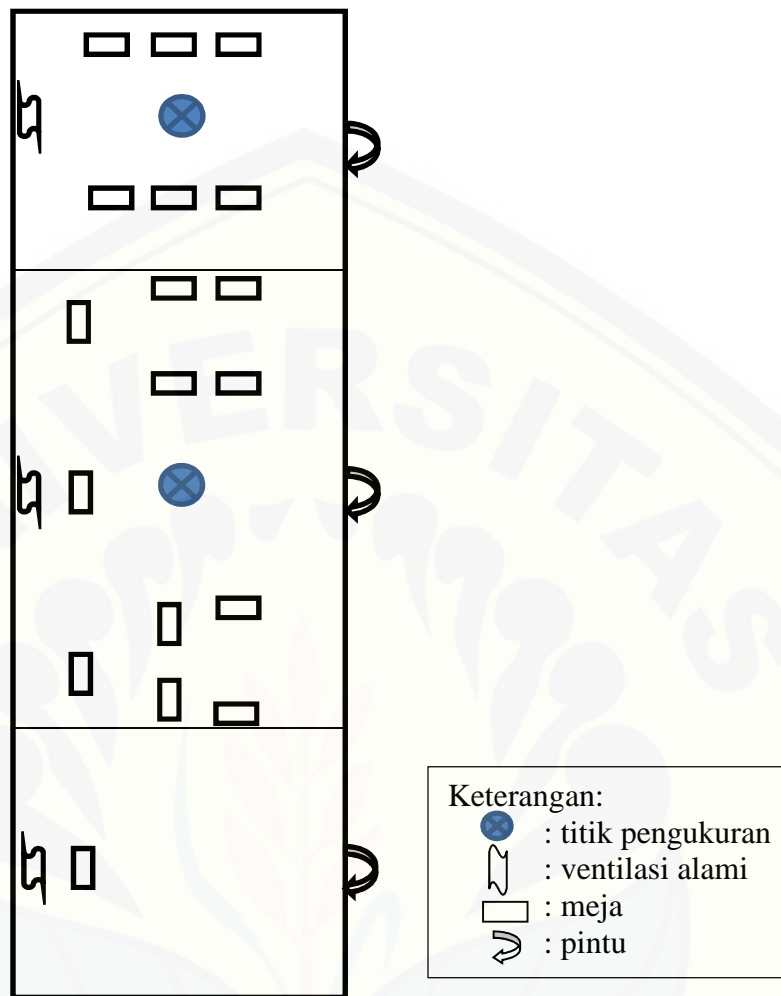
Denah Ruang Kantor Kelurahan Sumbersari
